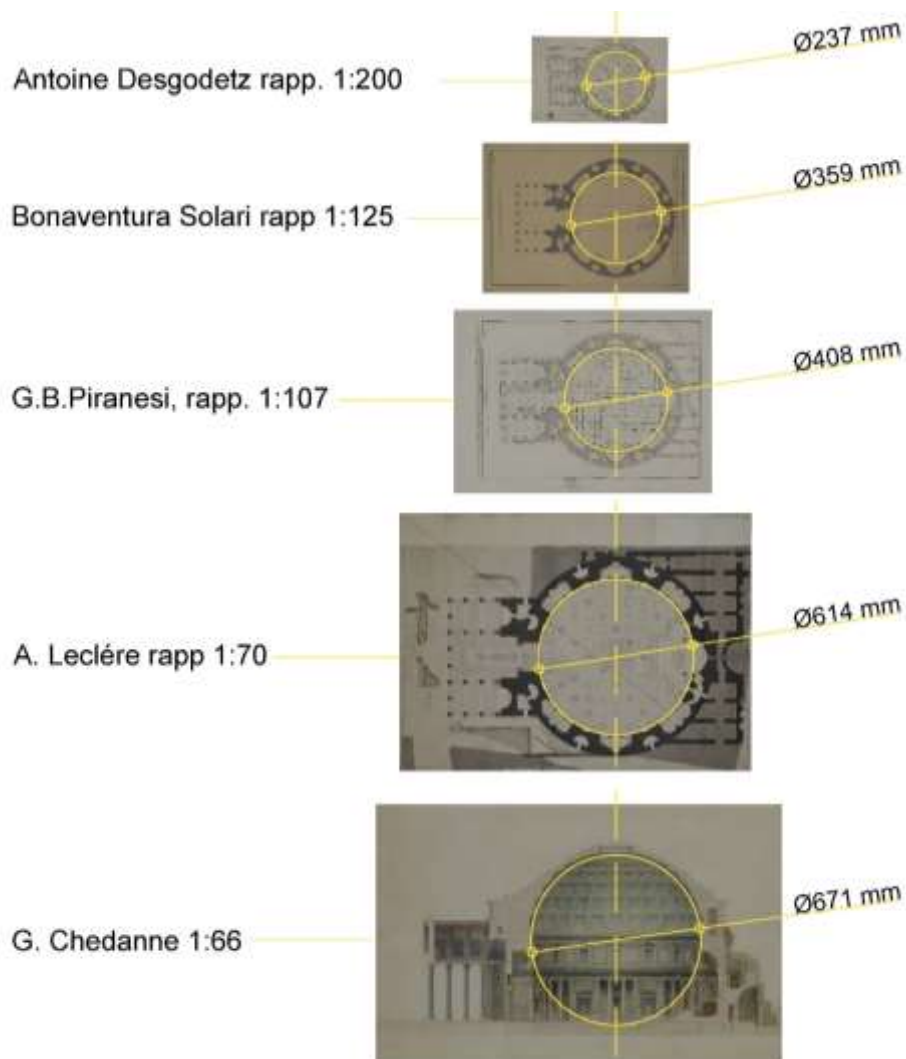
Le piante del Pantheon a confronto rispetto alle loro scale di rappresentazione.
